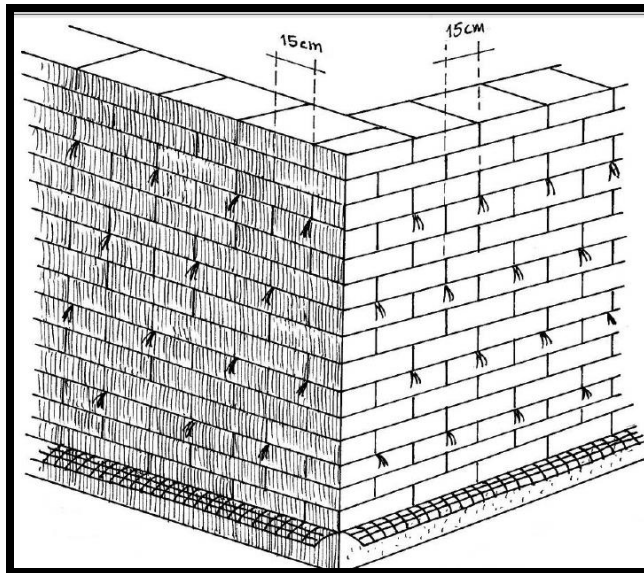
Distribución de rafia en hiladas de los muros de adobe
